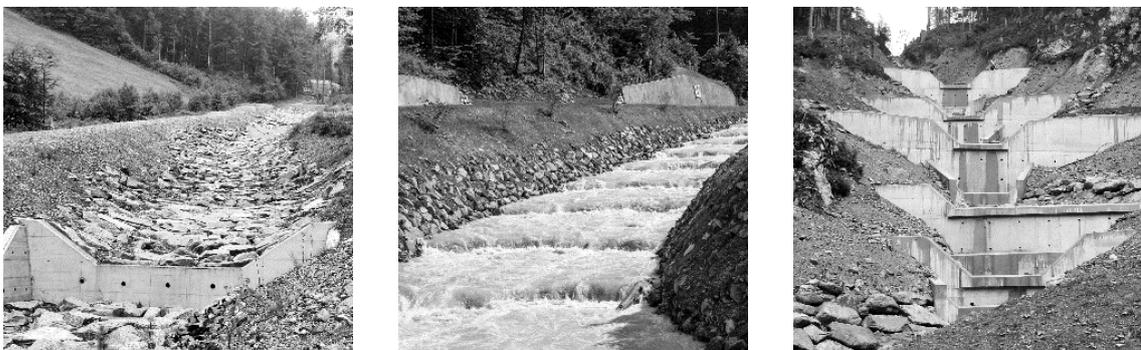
Geprüfte Varianten: Raubbett, Blockriegel im Hinterbeton, Betonsperrn
